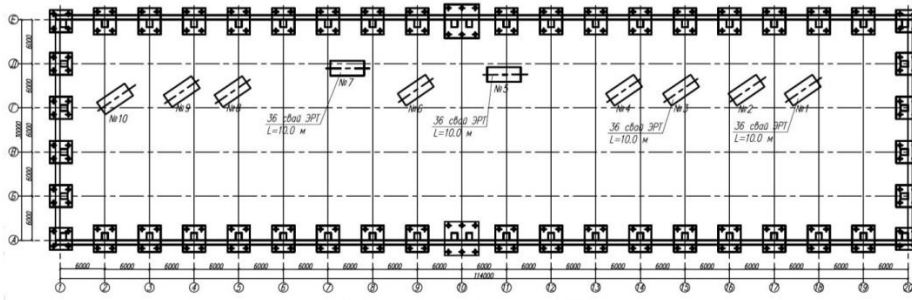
План свайного поля из буровнеэкссионных свай ЭРТ.
